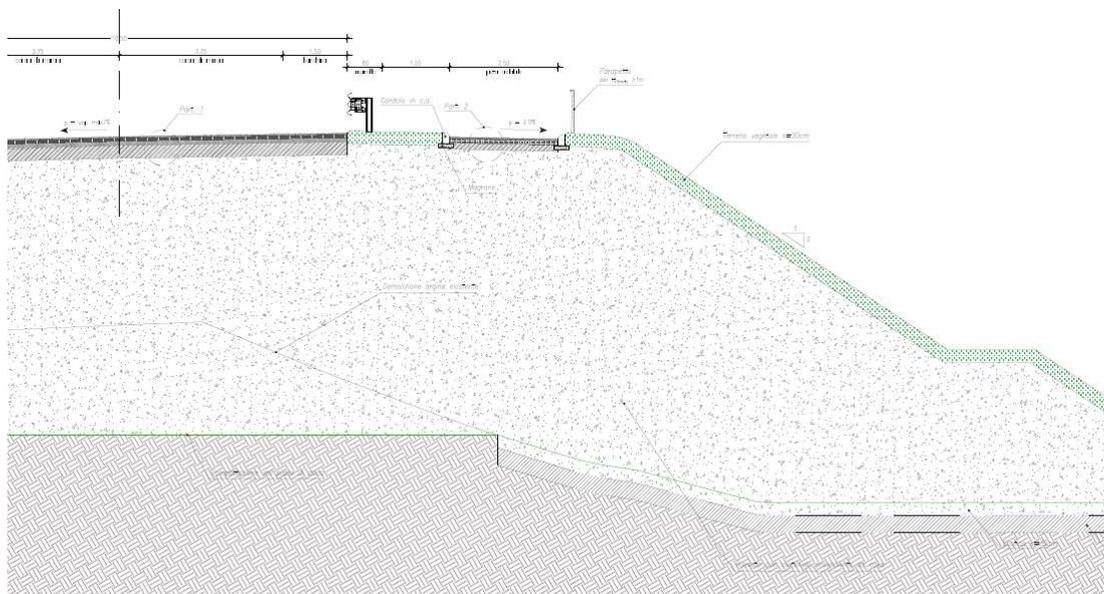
Sezione tipo pista ciclabile in affiancamento al tracciato stradale
